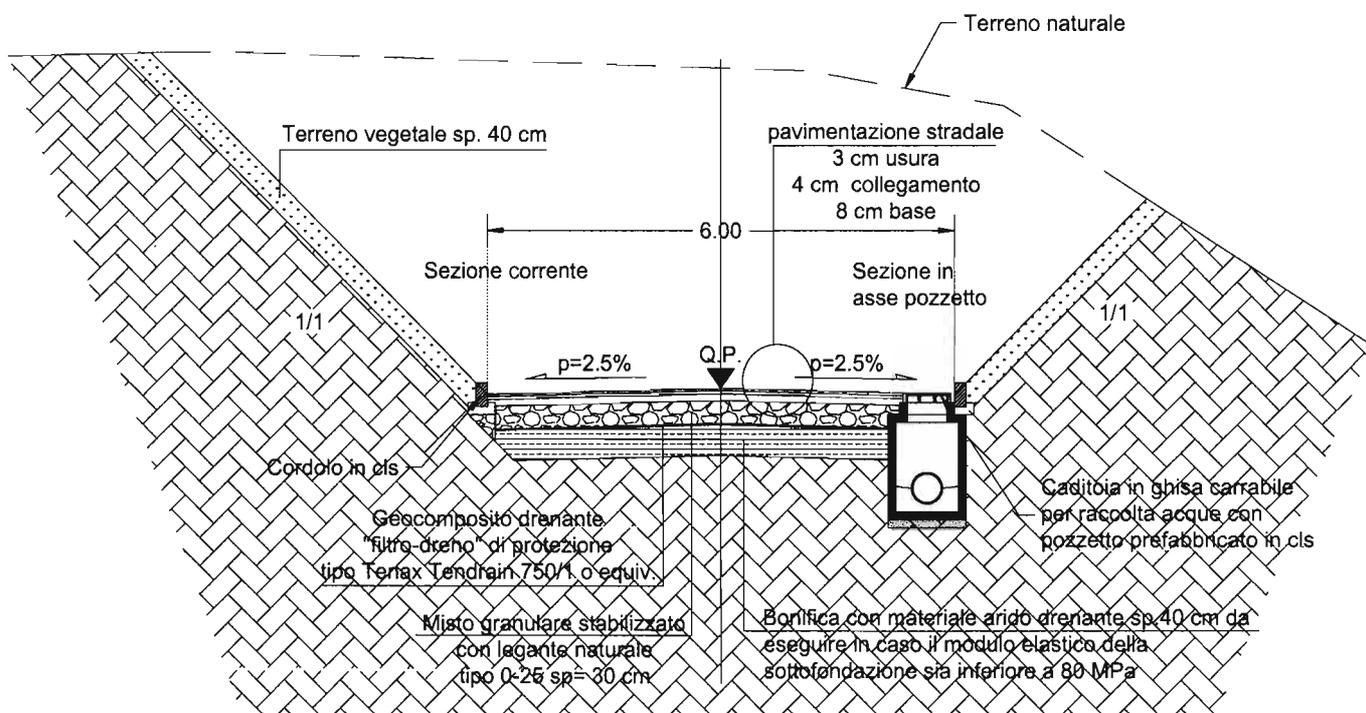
Sezione Tipo Strada Accesso Cantiere Albes
